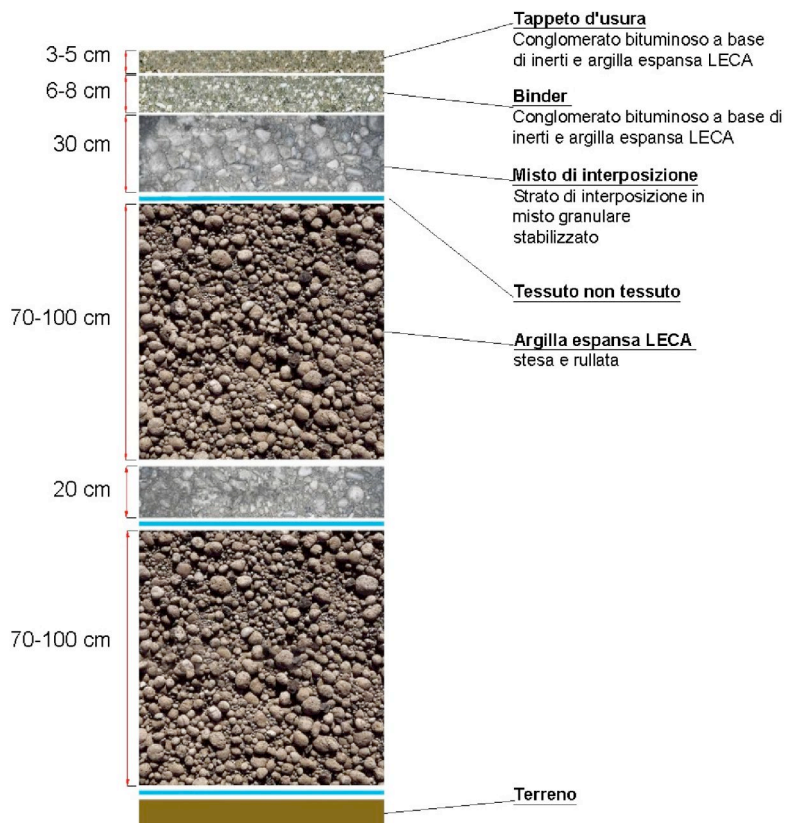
pacchetto standard per la realizzazione di un rilevato stradale.
